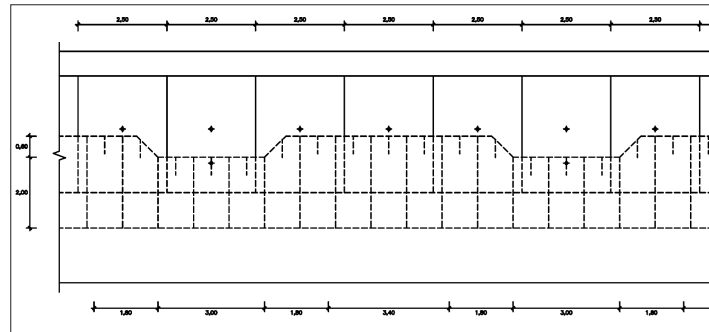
PRIMERA ETAPA DE LA PRIMERA FASE DE EXCAVACIÓN PARA EJECUCIÓN DE ANCLAJES DEL SEGUNDO NIVEL.
